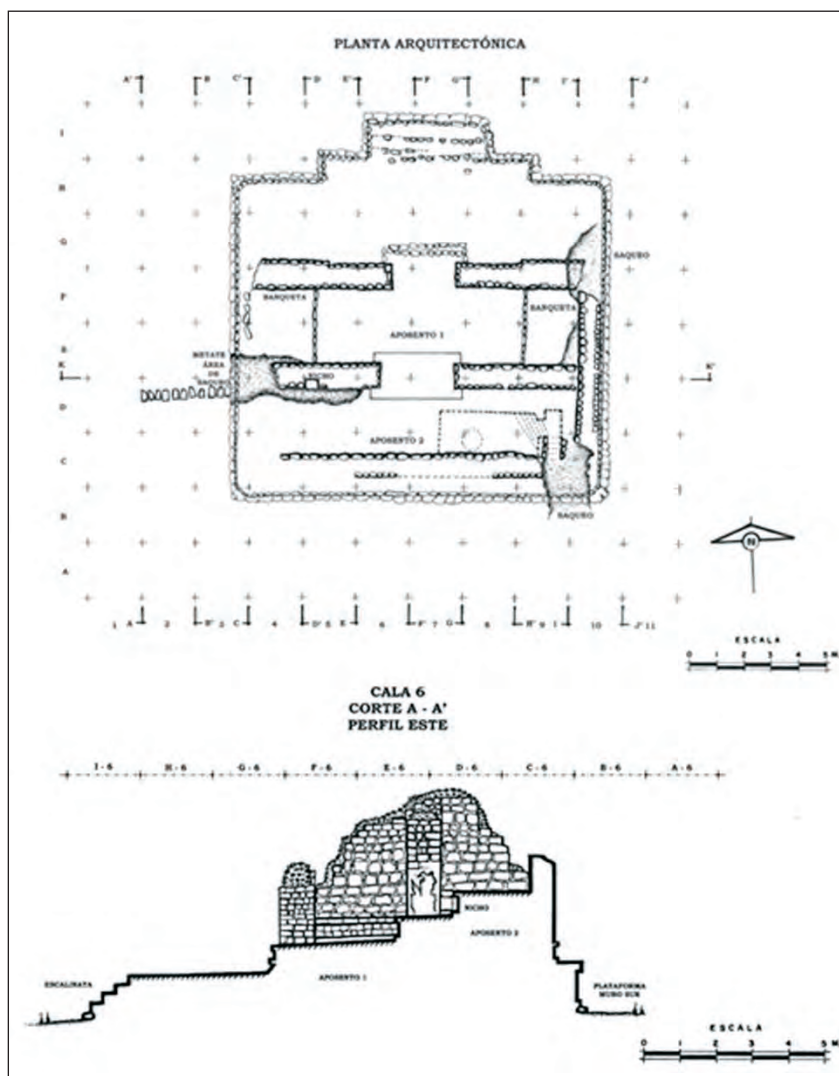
Planta arquitectónica y corte transversal este de la escultura VII.
